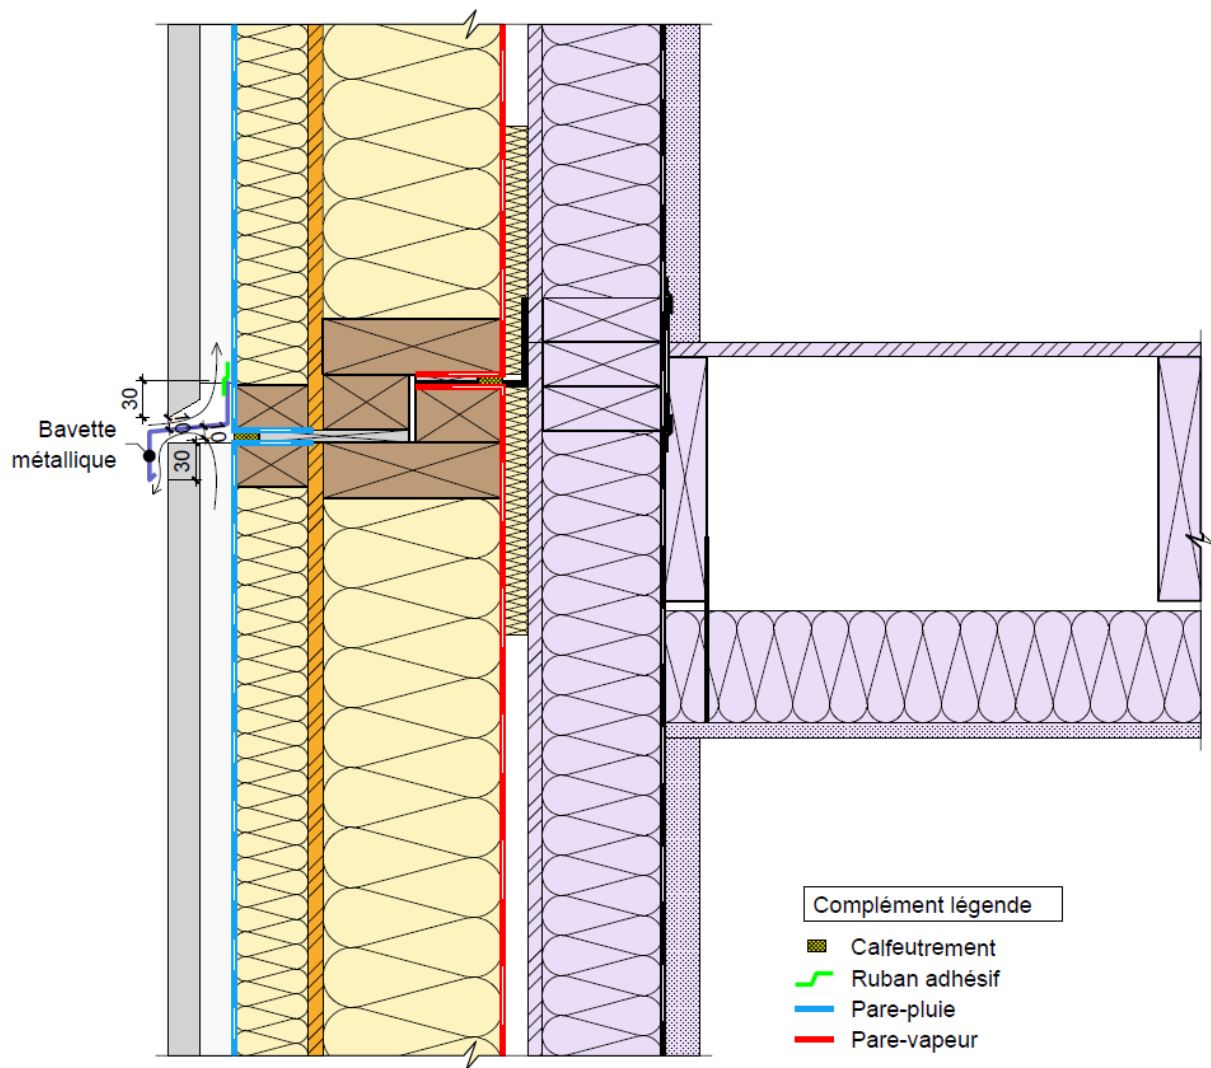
Plancher intermédiaire – avec recoupement de lame d’air du bardage (coupe verticale)
